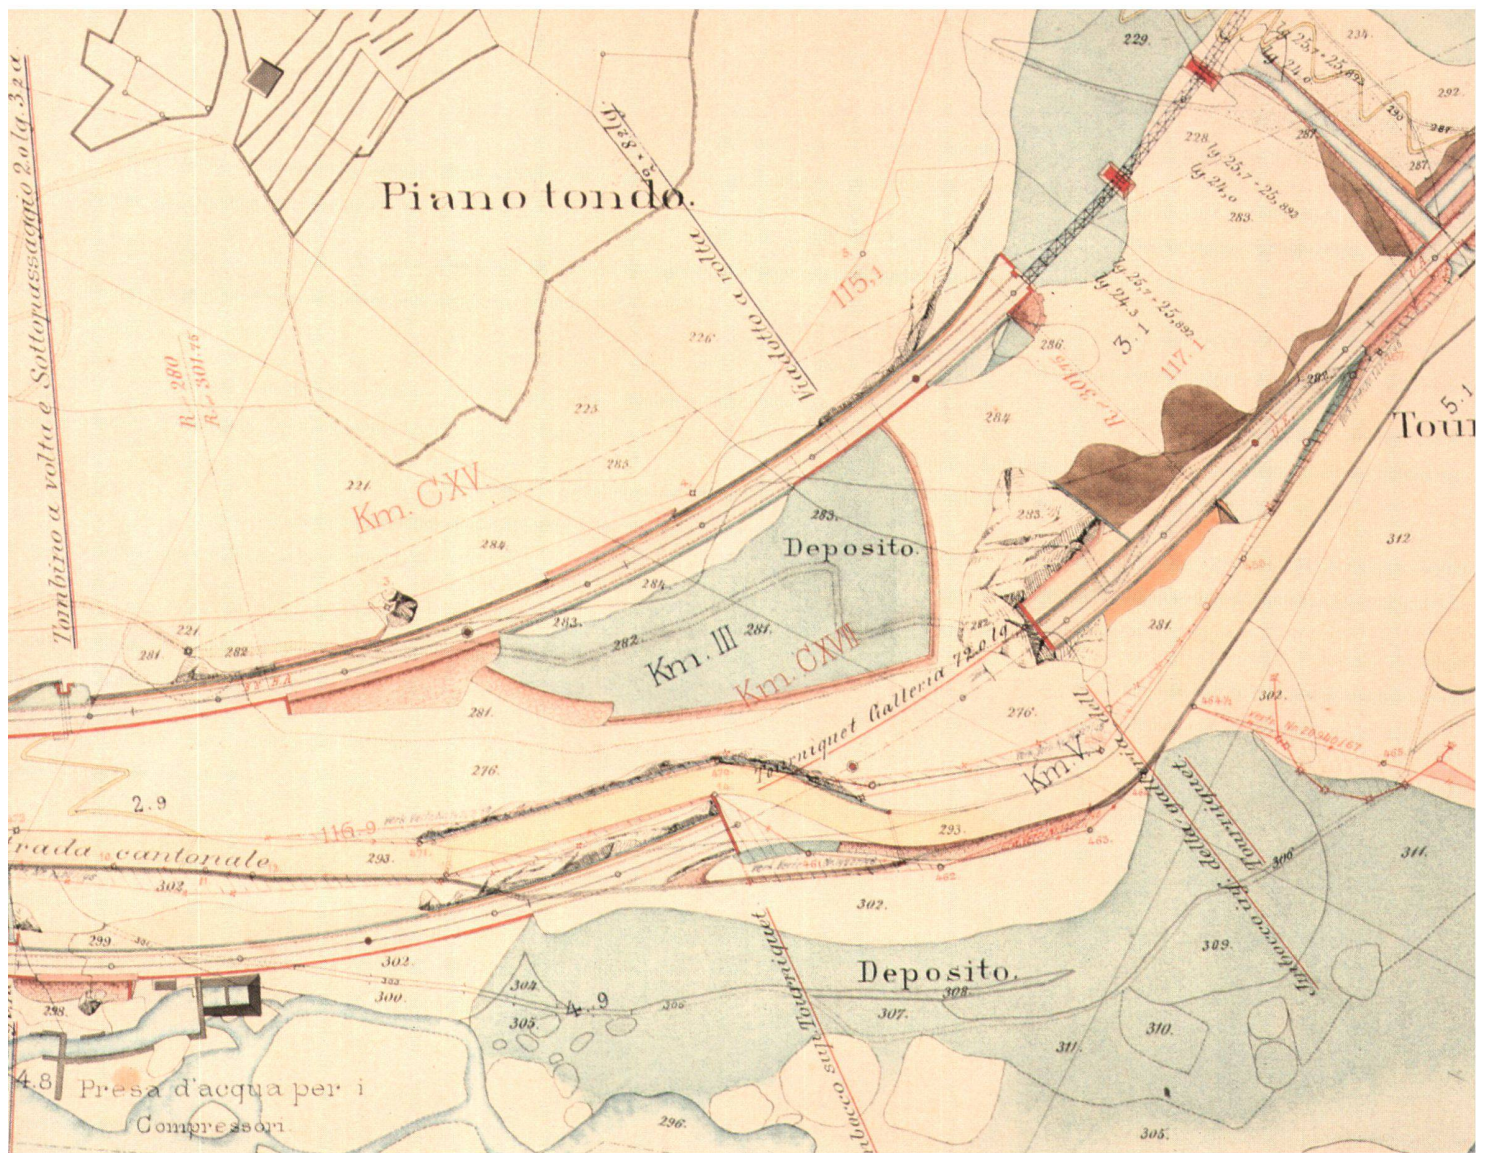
Ausschnitt aus dem «Catasterplan» der Gotthard-Bahn, Gemeinde Giornico aus dem Jahr 1884, Originalmasstab 1:1000 (Verkleinerung: ca. 1:1400).
